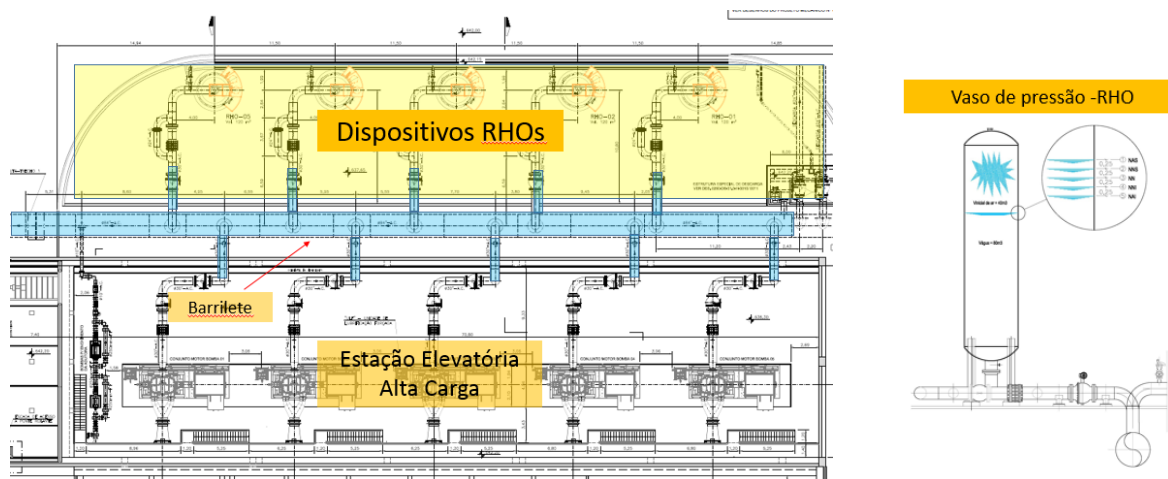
Dispositivos de proteção RHOs – Planta Layout e vista de elevação do vaso de pressão
